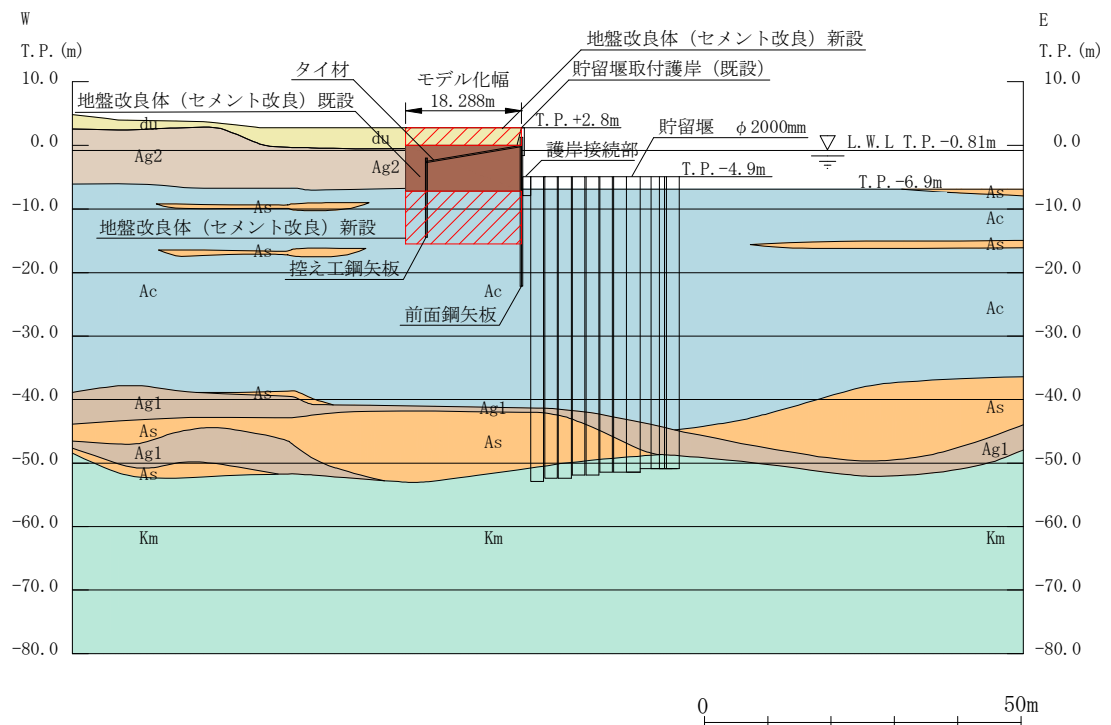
貯留堰取付護岸の評価対象断面図 (EW-1)
